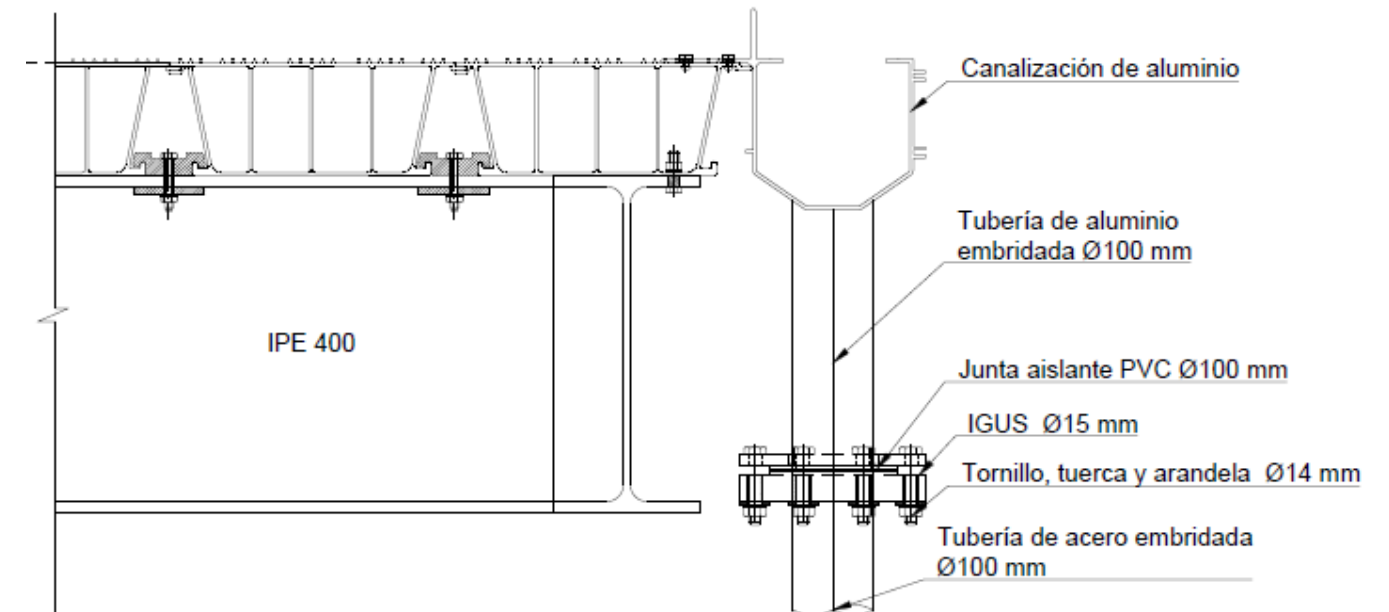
Unión sistema de drenaje con el tablero. Fuente: Propia.
